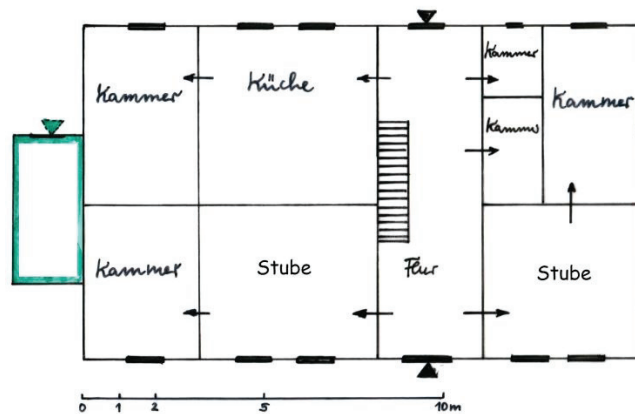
Grundriss ehemaliges Wohnhaus Familie Kohlmetz; nachträglich Anbau und heutiger Zugang grün gekennzeichnet, Grundriss weitgehend erhalten, bewohnt
